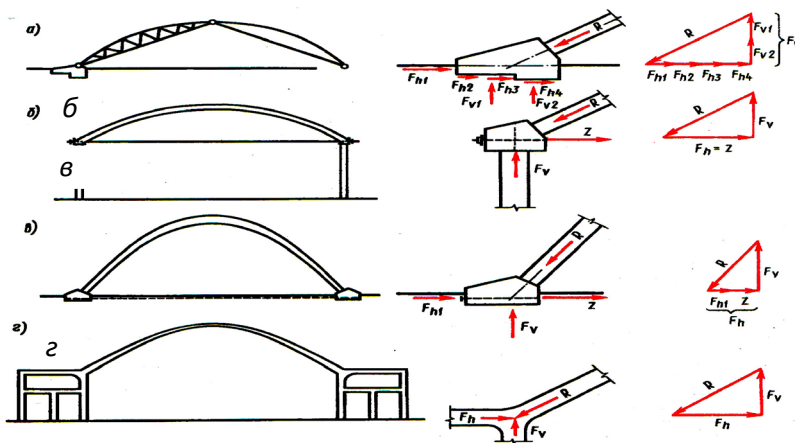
Варіанти сприйняття розпору в арках: а – фундаментами і ґрунтовими основами; б – затяжкою в рівні опорних вузлів; в – затяжкою в рівні підлоги і фундаментами; г – конструкціями прибудованих рам
